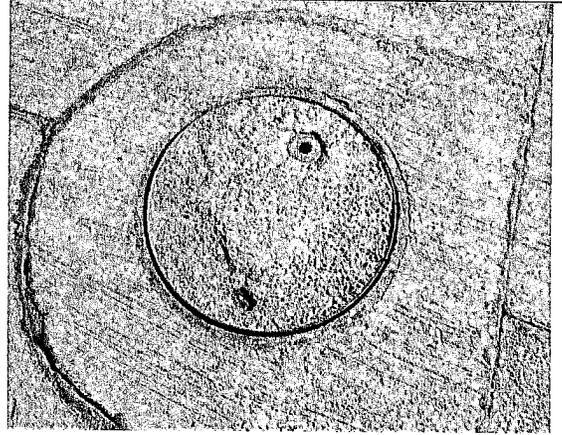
TAPA CÁMARA CON HORMIGÓN DESGASTADO
